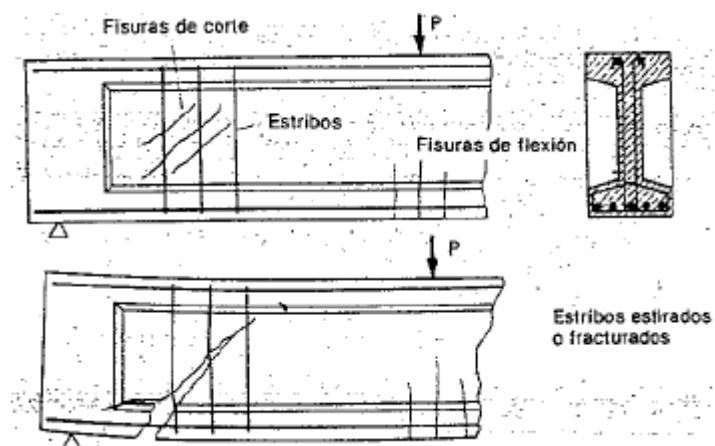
Arrancamiento del extremo de viga y fisuración por corte en la zona de apoyo.
